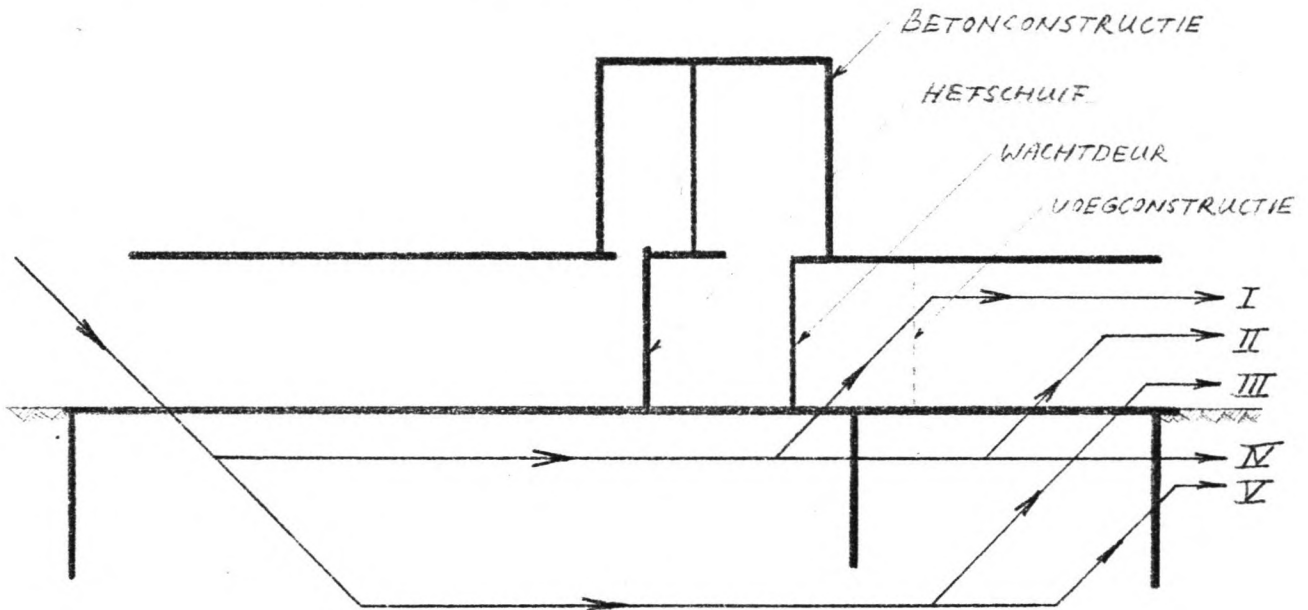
, Schematisatie van de verkorte kwelwegen, bij lekkage door de betonconstructie en/of de damwandschermen.
